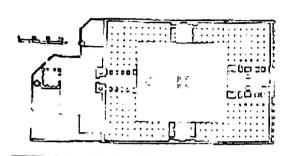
حيس، الجامع الكبير، المسقط الأفقي كما وضعته بريارا فنستر
